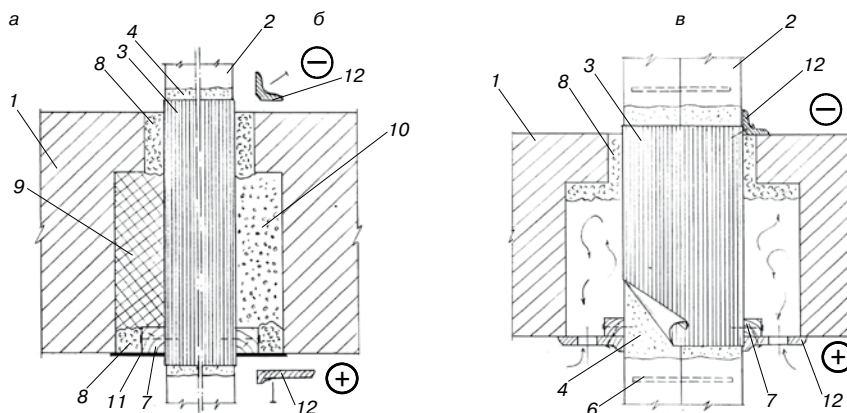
Узлы пересечения клееной деревянной балкой наружной стены отапливаемого здания: а – с утеплением зазоров плитным утеплителем (вариант 1); б – то же, заливочным пенополиуретаном (вариант 2); в – без утепления с вентилируемым зазором (вариант 3); 1 – наружная стена; 2 – клееная деревянная балка; 3 – влагоизоляционный бандаж; 4 – поверхность, обработанная антисептиком; 5 – спаренная клееная деревянная балка; 6 – вклеенный металлический стержень; 7 – деревянный брусок сечением 40×40 мм; 8 – монтажная пена; 9 – плитный утеплитель (Roswool Лайт Батсс, Isover KL 34); 10 – заливочный пенополиуретан; 11 – Герлен-Д; 12 – нащельник
